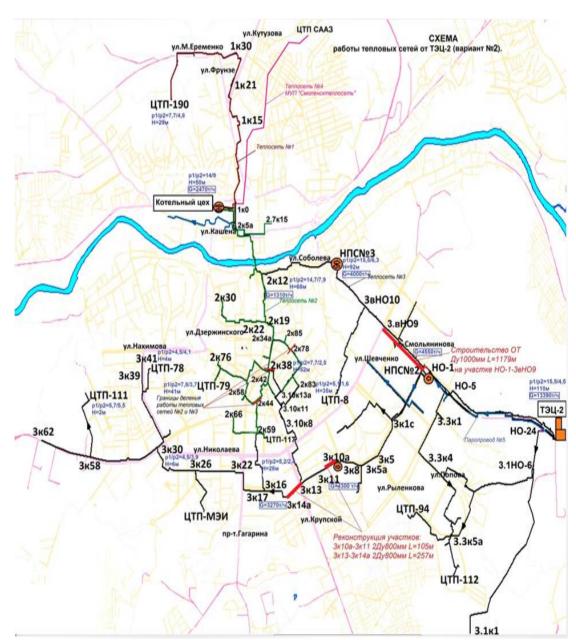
Схема теплоснабжения после перевода тепловой нагрузки с котельного цеха на Смоленскую ТЭЦ-2
